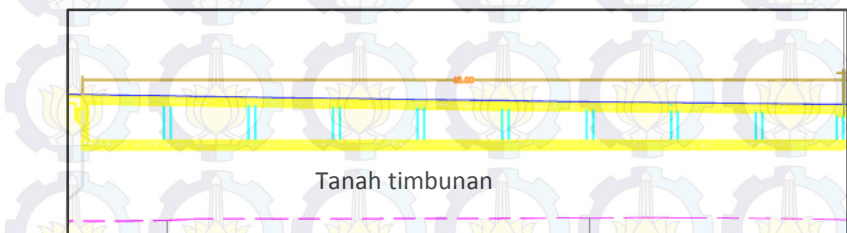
Dimensi slab column slab sisi kiri zona 1 potongan A-A
